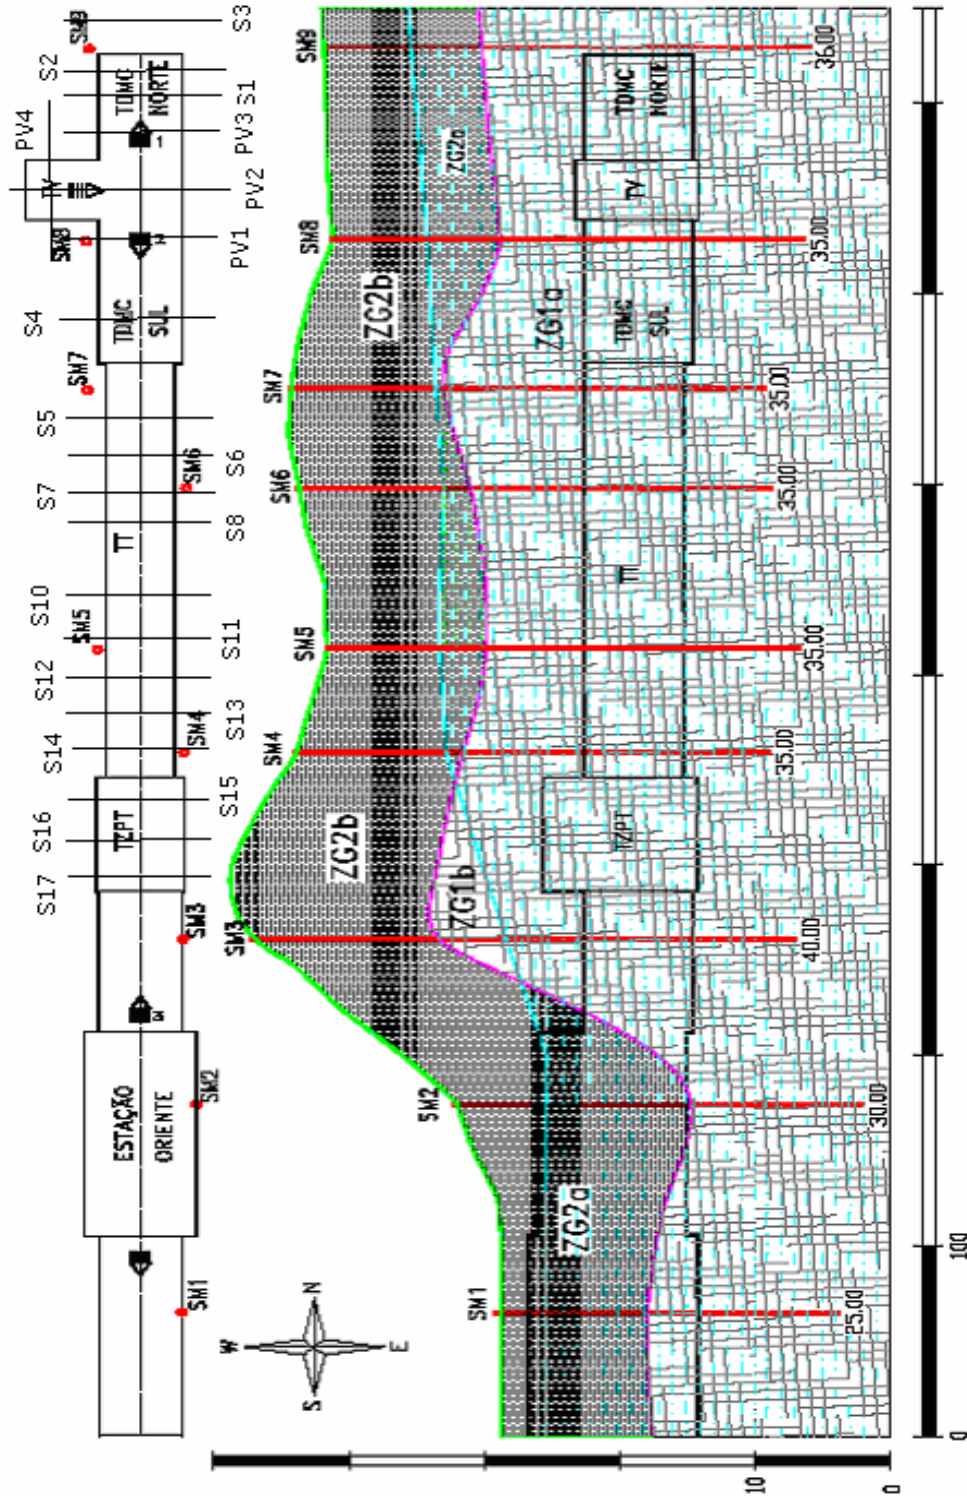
Término do Oriente. Planta esquemática do traçado e perfil geotécnico do maciço (adaptado de Martins *et al.*, 2004)
